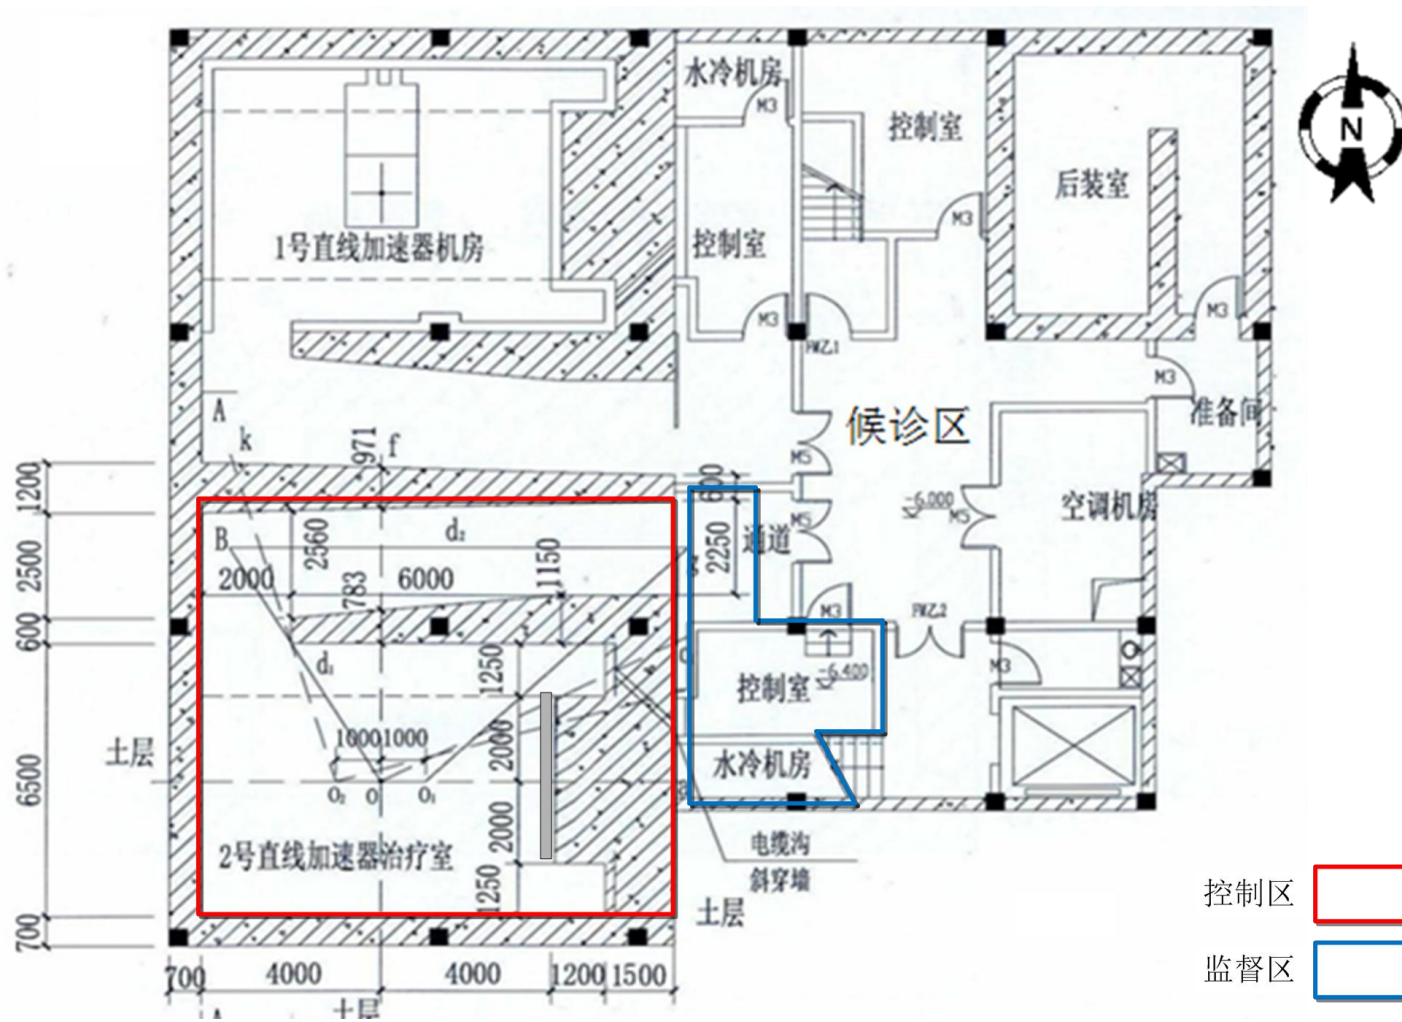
本项目 2 号医用直线加速器机房周围环境平面布置图
